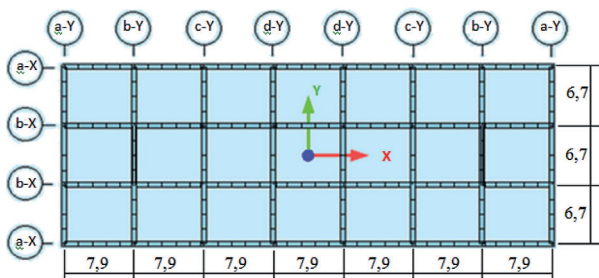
Planta baixa, dimensões em metros (ORRALA, 2017).
